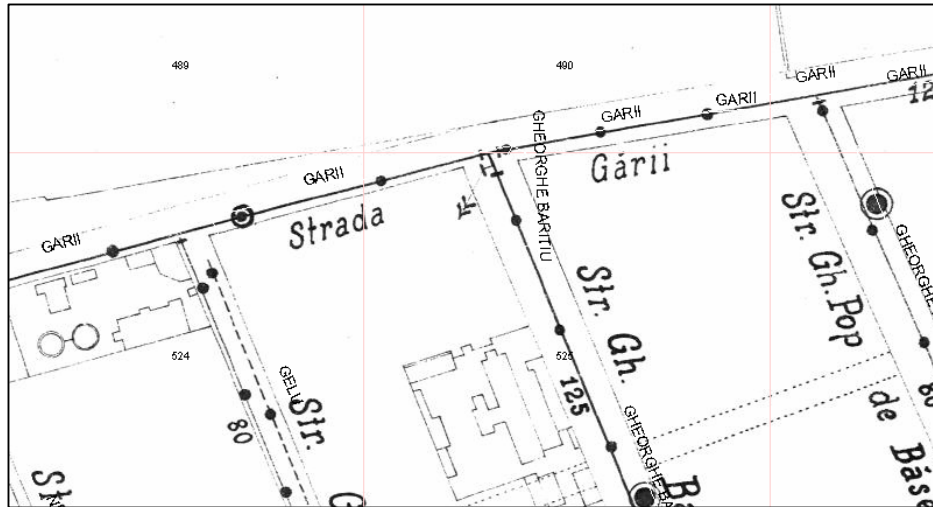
Fragment plan situație rețele apă construite în perioada 1912-1914 digitizat și georeferențiat
